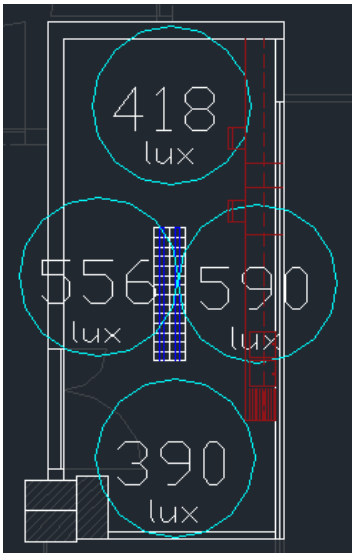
Planta Autocad da Farmácia com Medição de Iluminância
